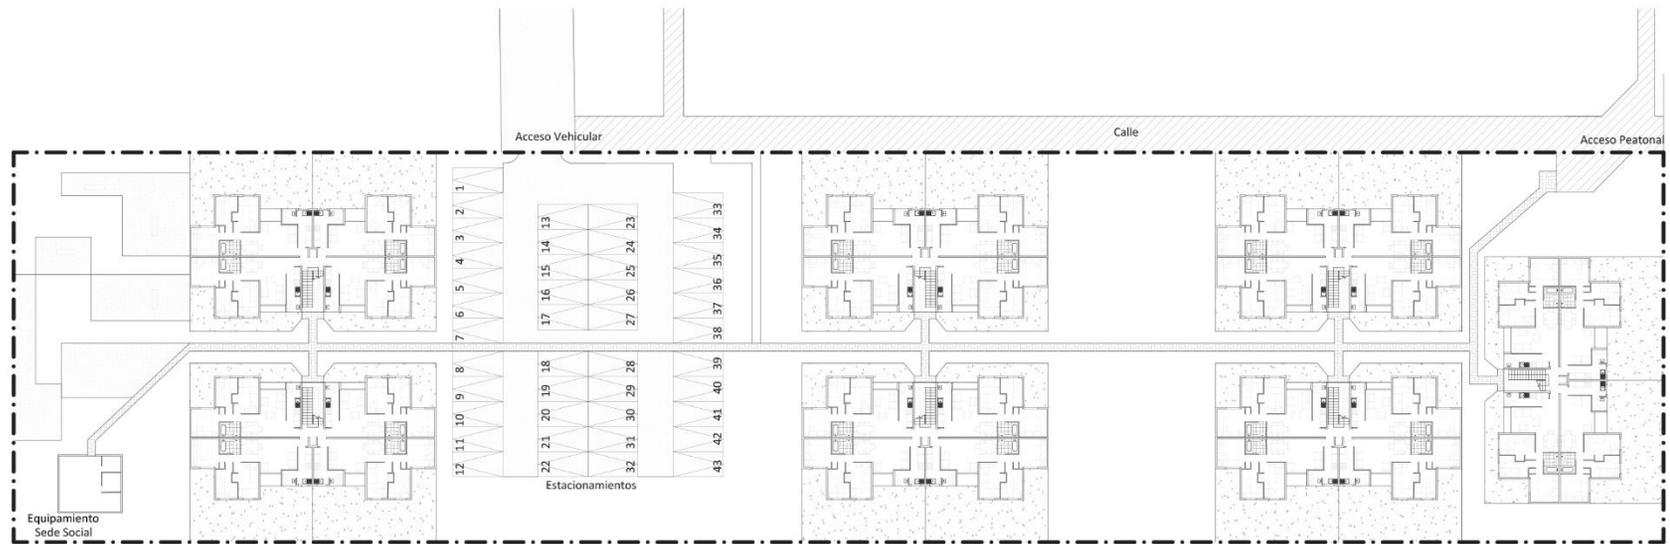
Plano loteo conjunto Don Eduardo escala 1:750 . Fuente: Elaboración propia
